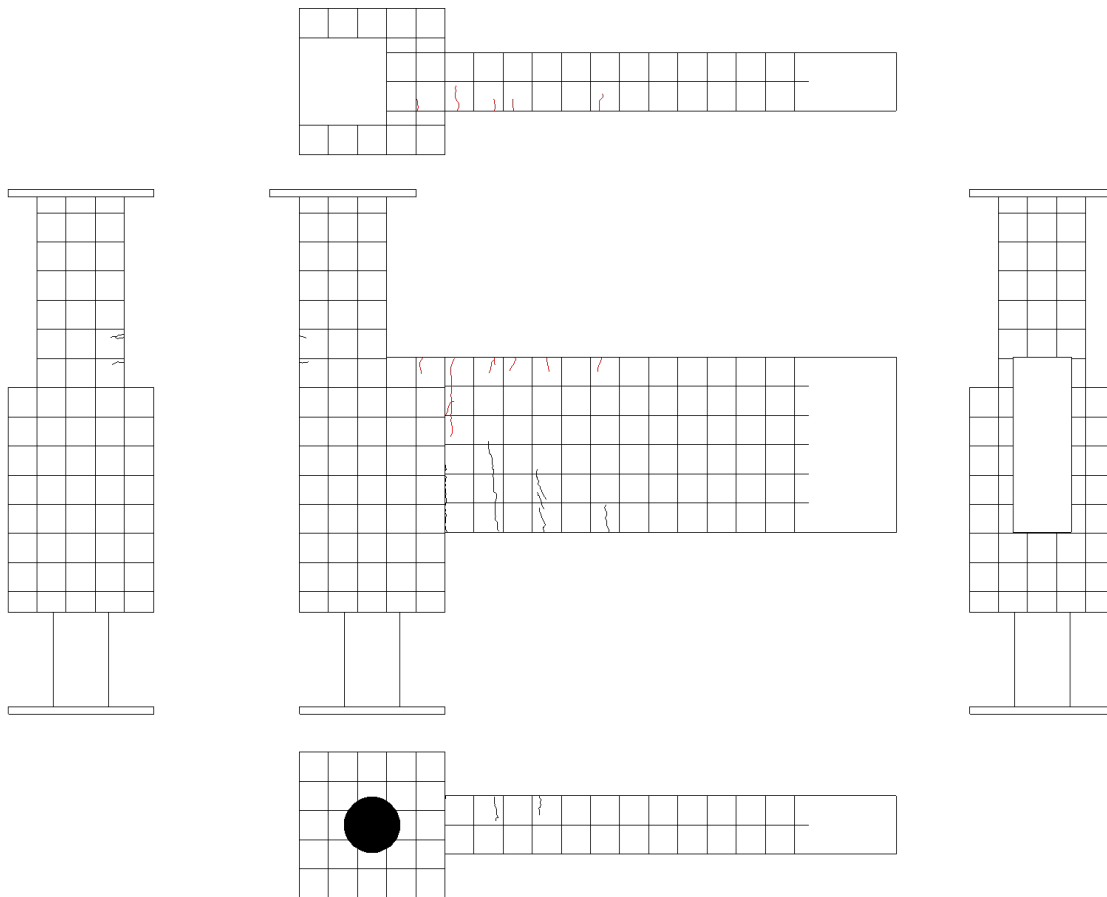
3. 82 試験体 B-1 ひび割れ状況 (9Cycle)
